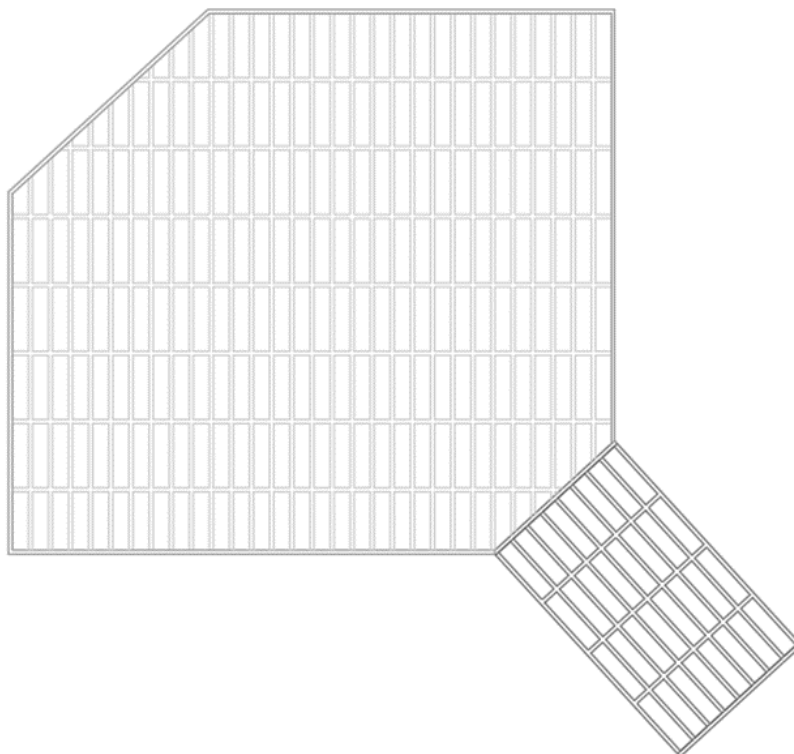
Quinta Bolívar, cielorraso planta baja, vista inferior. Fuente y elaboración: Autor.
